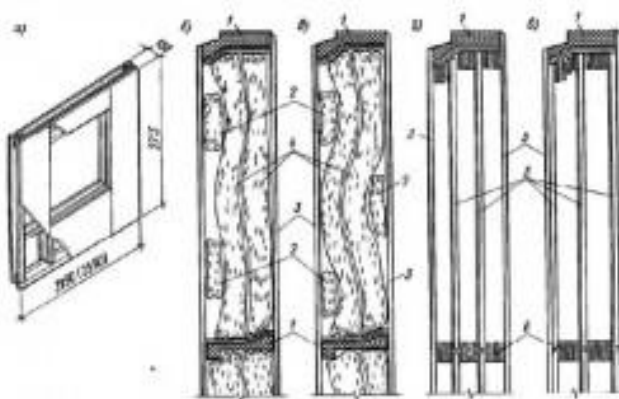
Асбестоцементные каркасные стеновые панели:
